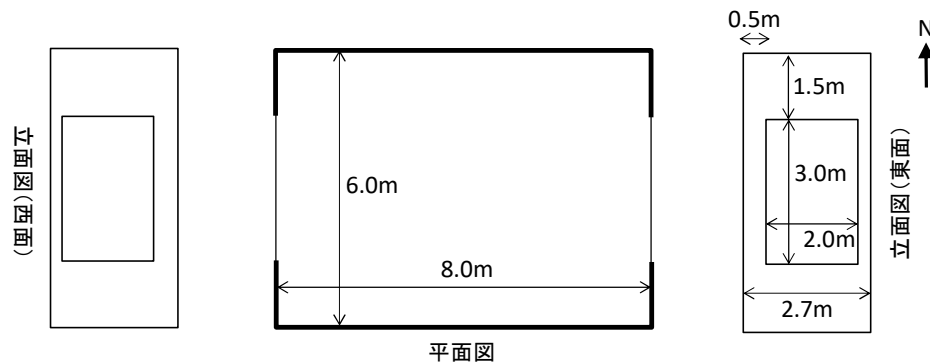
1 L-SIN620モデル建物平面図および立面図
